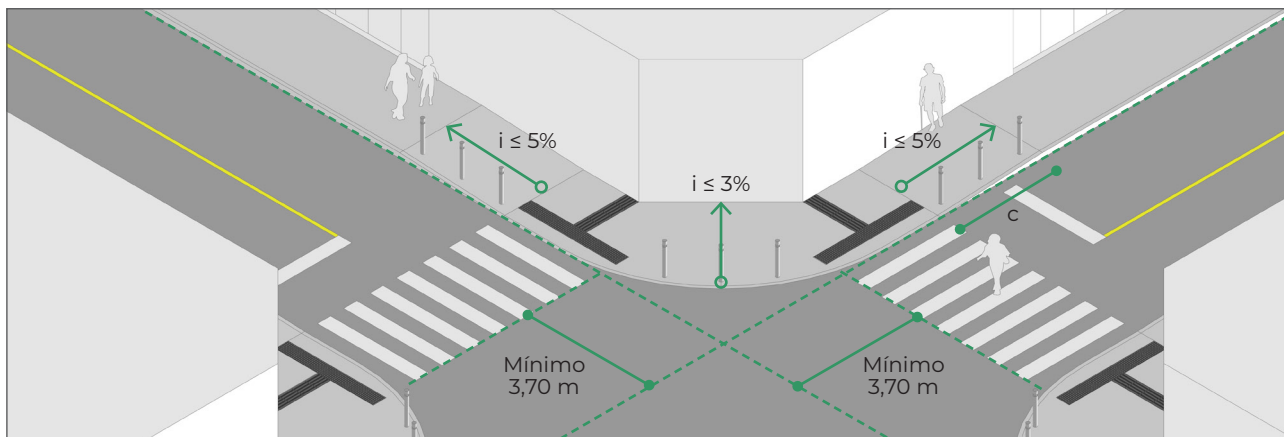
Travessia em esquinas rebaixadas com dispositivos de bloqueio. Essa solução é recomendada principalmente em áreas centrais com grande fluxo de pedestres, pois facilita a fluidez do deslocamento.
